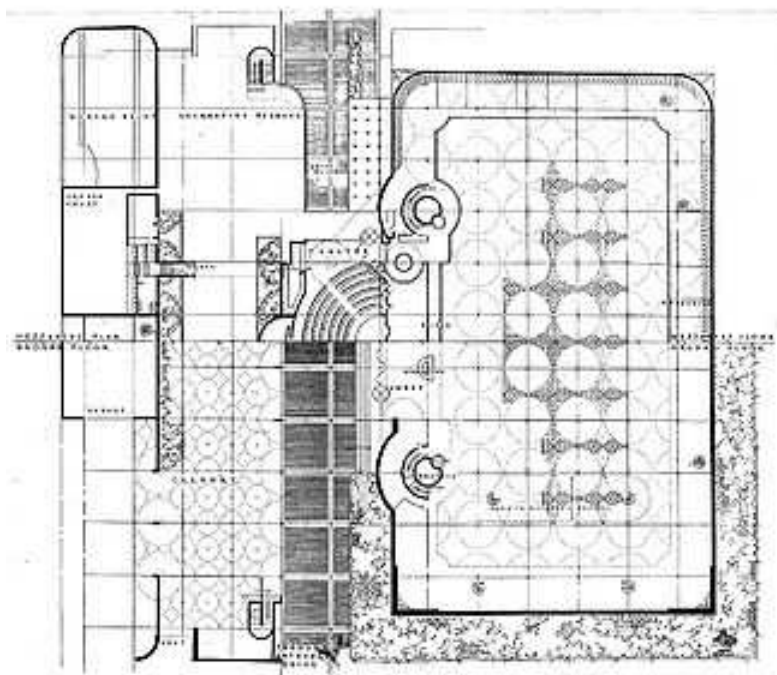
Planta de las oficinas Johnson, obra de Frank Lloyd Wright
